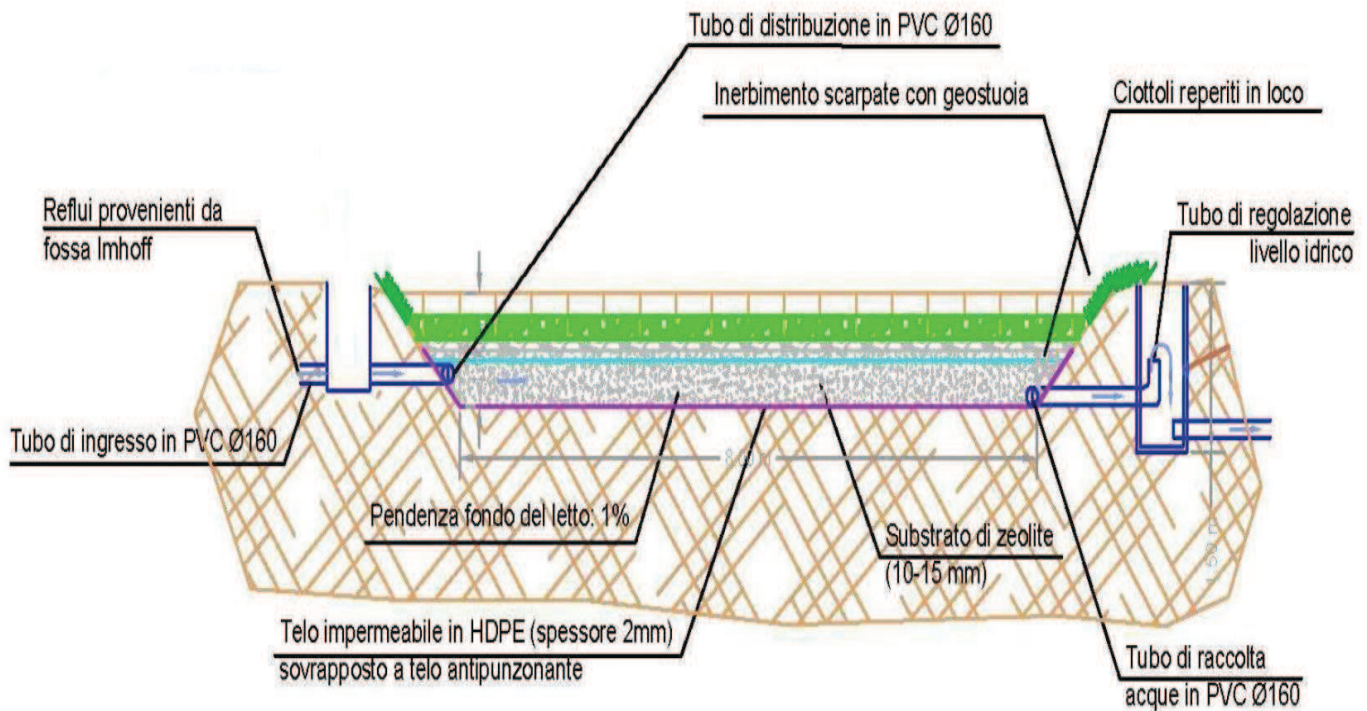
Sezione del impianto al Rifugio Tonolini scala 1:100;(fonte: Parco dell'Adamello)
